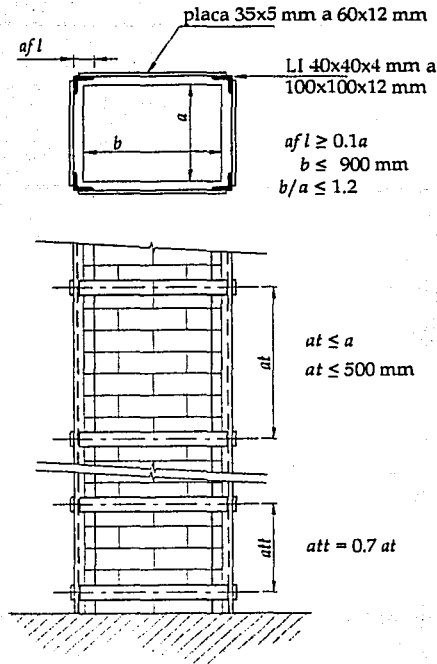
Reforzamiento de columnas de mampostería con cinturones de acero (Pume, 1989).
